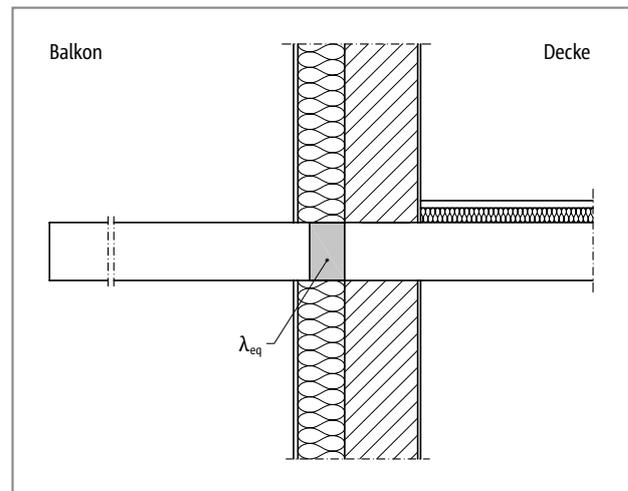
Darstellung einer Schnittzeichnung mit vereinfachtem Ersatzdämmkörper
